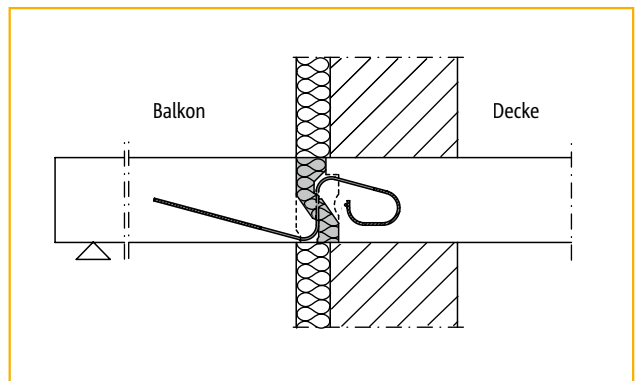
Mauerwerk mit Außendämmung bei deckengleichem Balkon
